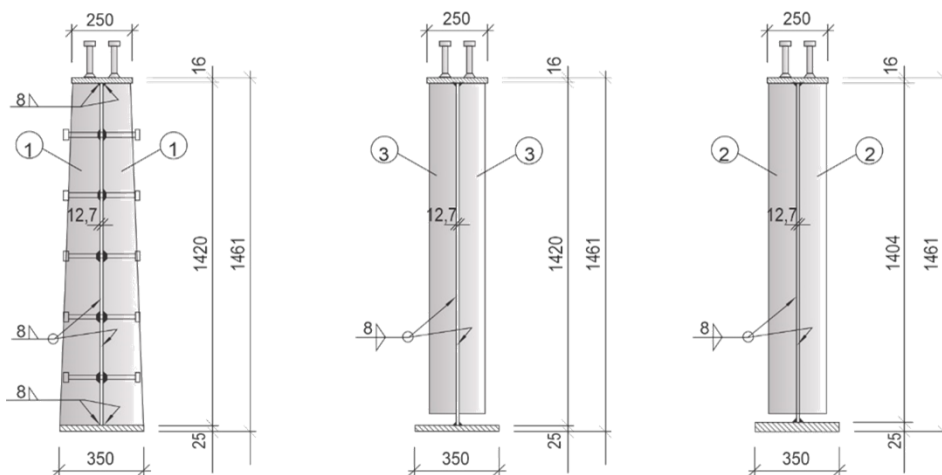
Detalhamento das Vigas Longarinas | (a) Ponte Arataú | (b) Ponte Anapú | (c) Ponte Poraquê
